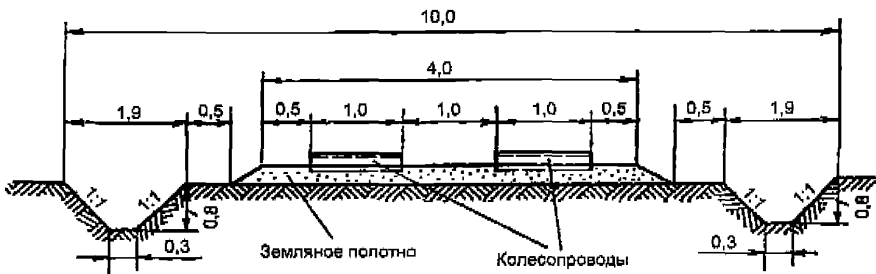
Поперечный профиль лесных дорог из железобетонных плит для условий типа местности II на грунтах, годных для укладки в земляное полотно
